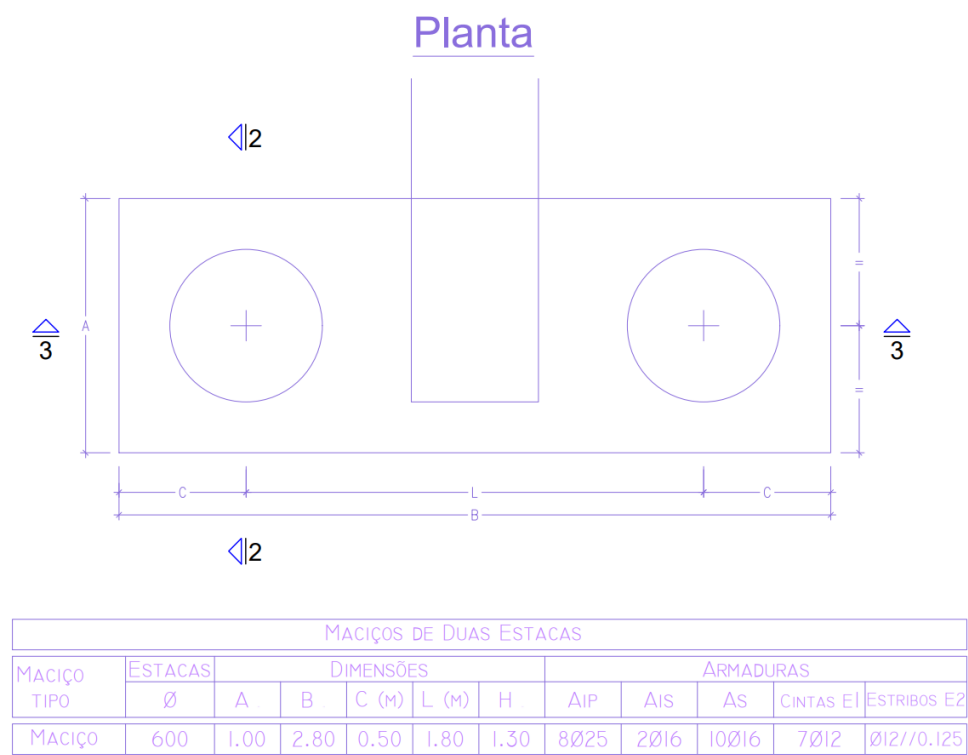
Pormenor. Planta de Maciço de duas estacas. Fonte: Projegui.
